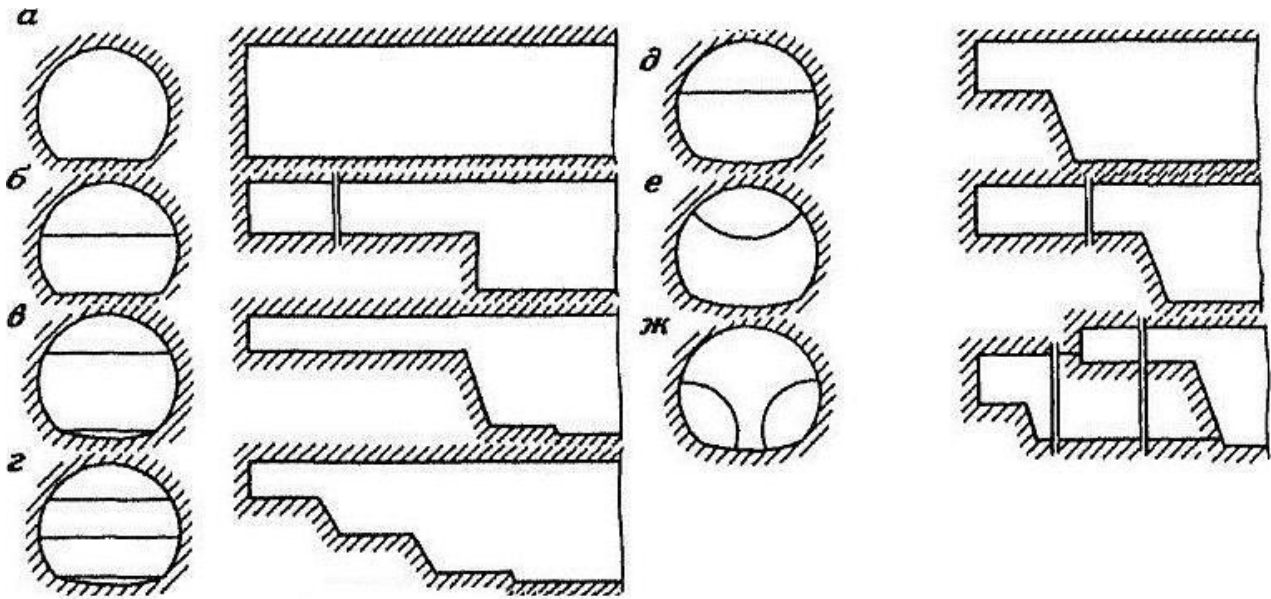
Схемы разработки тоннеля новоавстрийским способом:
